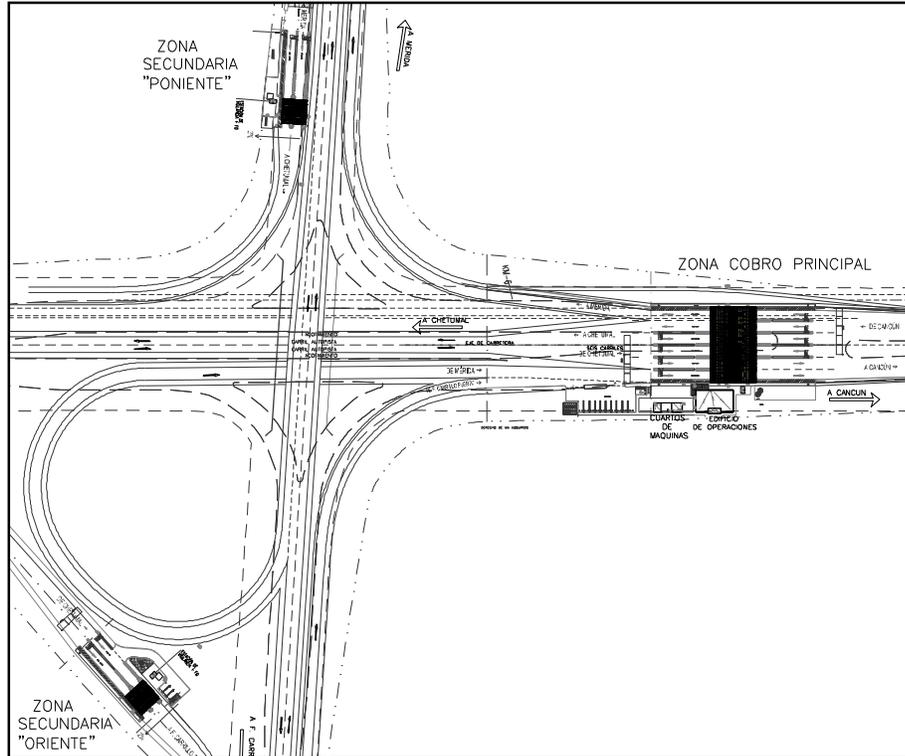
PLANTA DE LA DISTRIBUCION DE CASETAS DE COBRO
